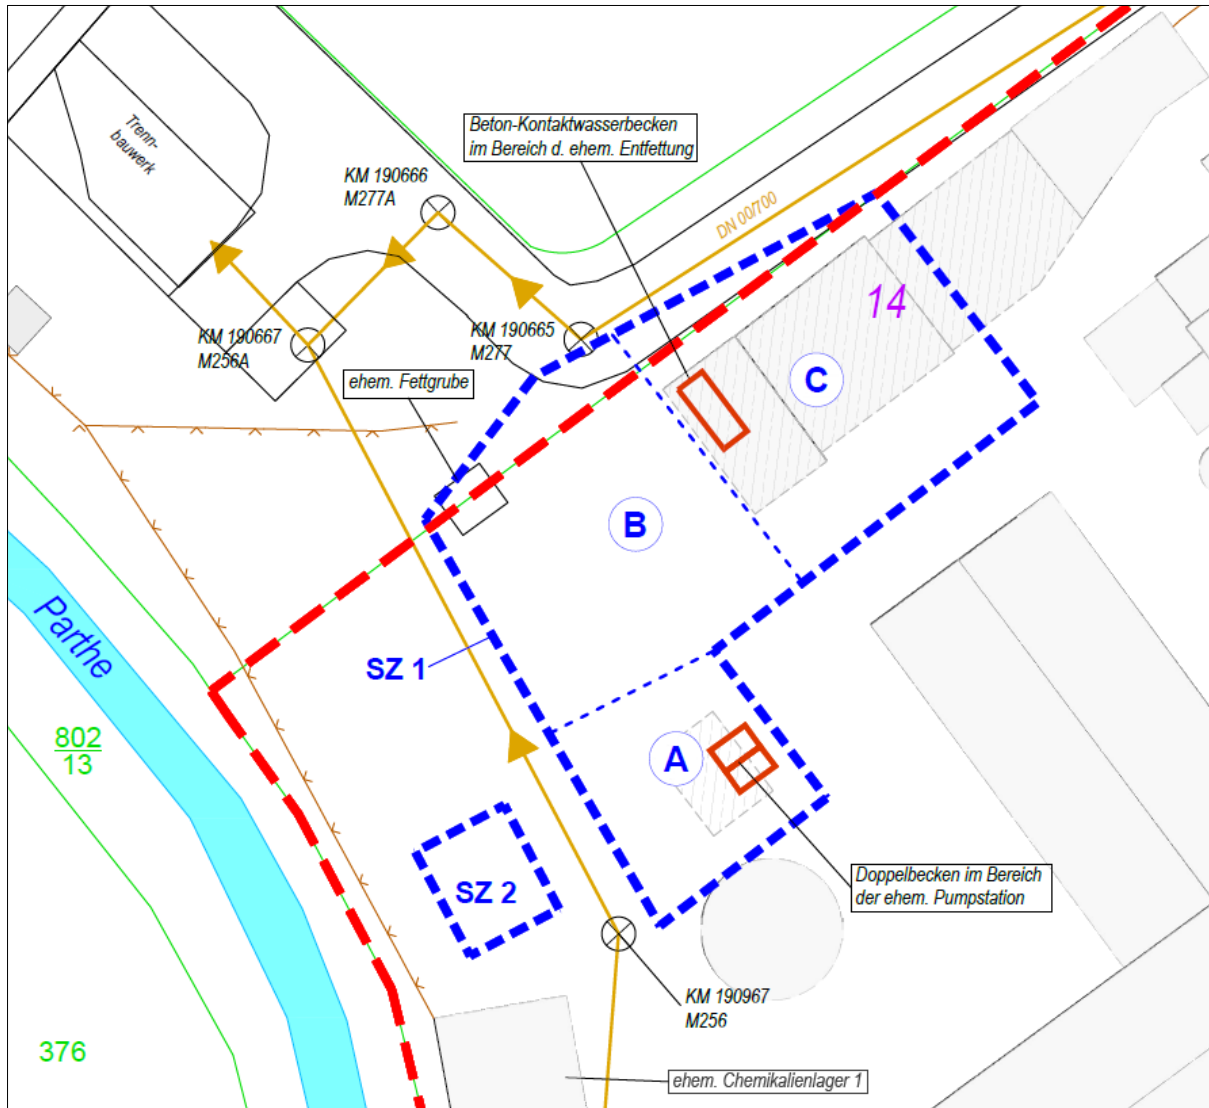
Lageplan mit Darstellung der Sanierungszonen (BEYER UMWELT CONSULT)
